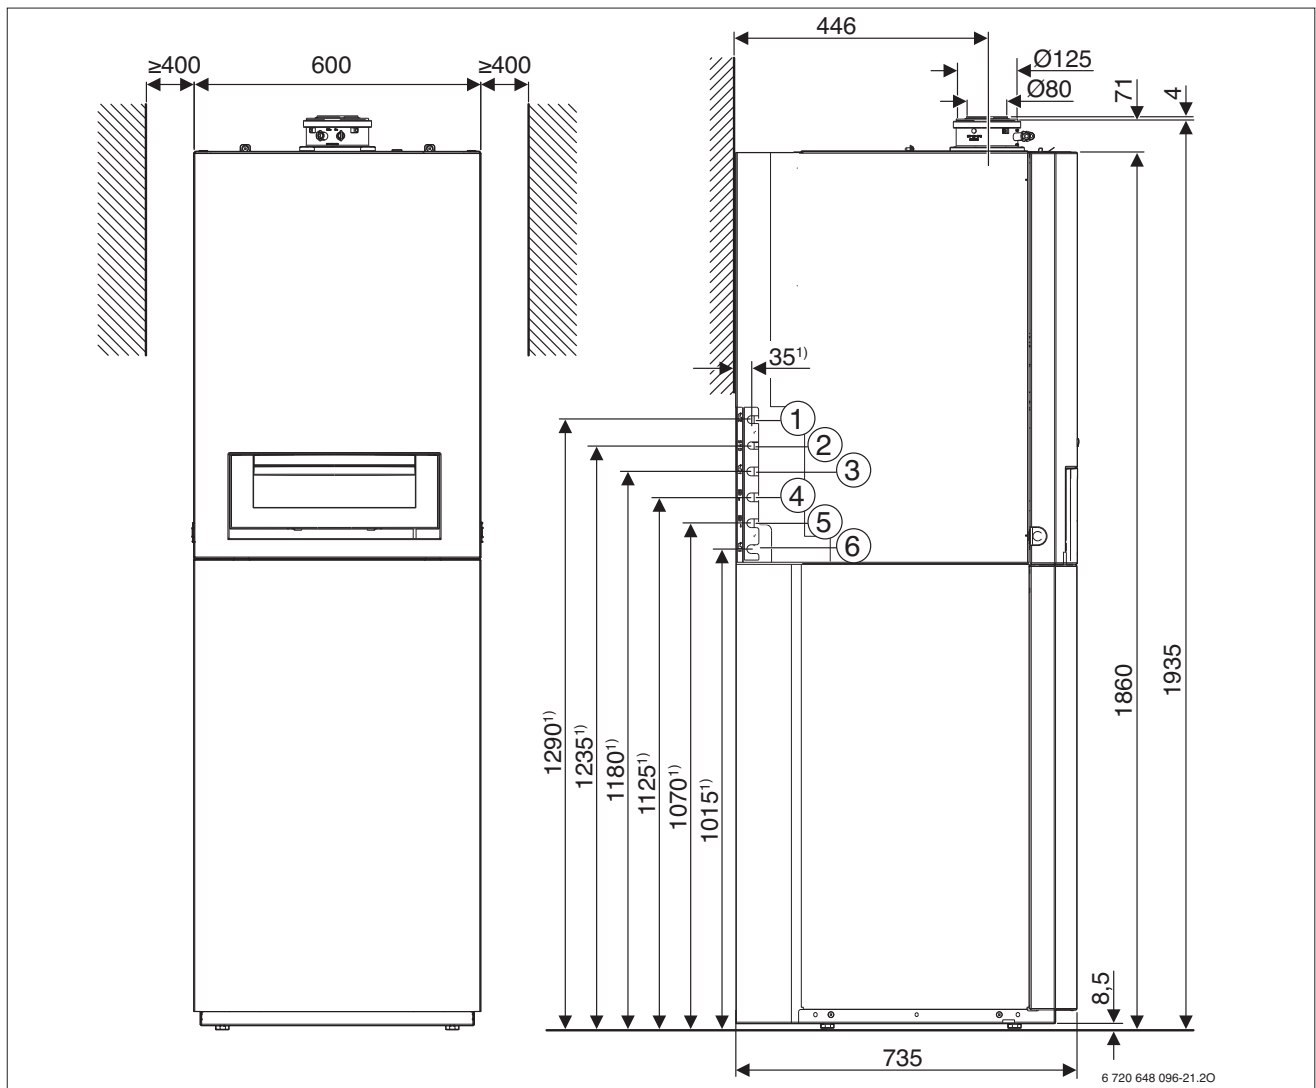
Abmessungen und Anschlüsse für GB172-14/20 T210SR (Maße in mm) mit Blende hinten (Zubehör, inklusive Anschluss-Set seitlich, lang)
